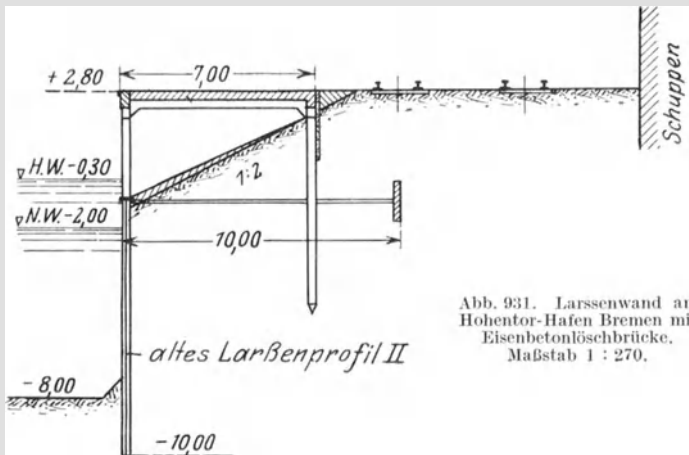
Larssenwand am Hohentor-Hafen Bremen mit Eisenbetonlöschbrücke. Maßstab 1 : 270.
